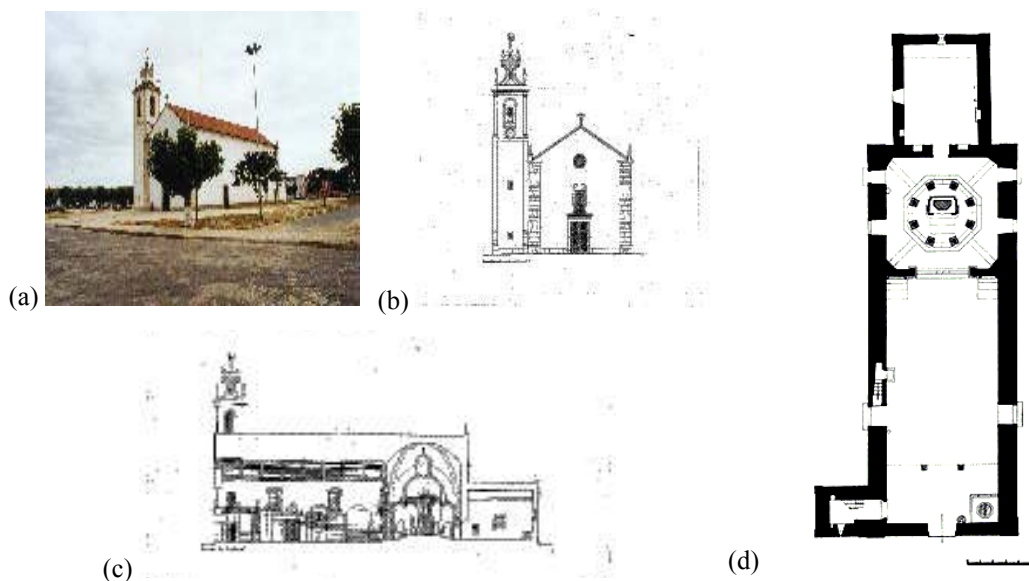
Peças desenhadas [Fonte: DGEMN]: (a) fotografia; (b) alçado da fachada (c) corte longitudinal; (e) planta.
